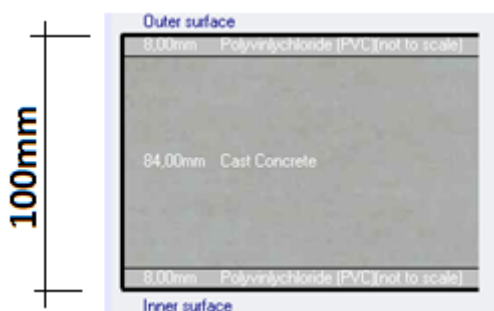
Seção esquemática da parede de Concreto-PVC modelada no DesignBuilder.
